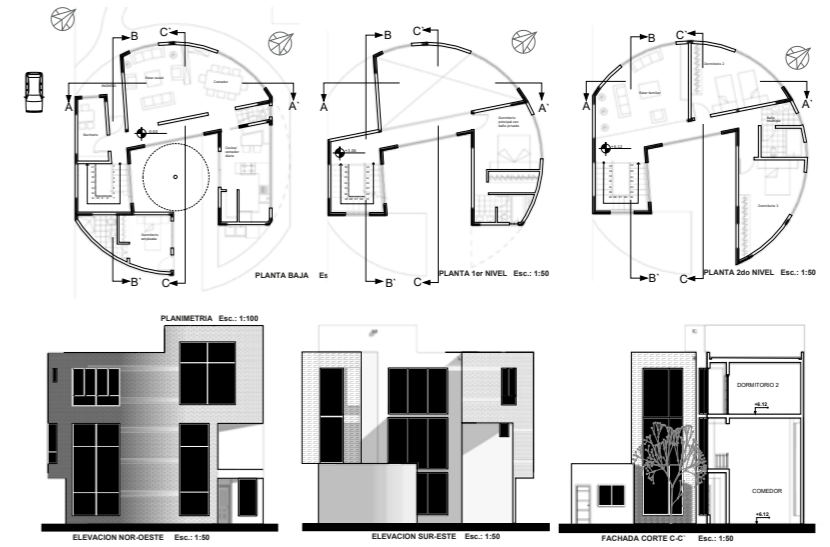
Plano Arquitectónico - Proyecto Vivienda /Huerto
